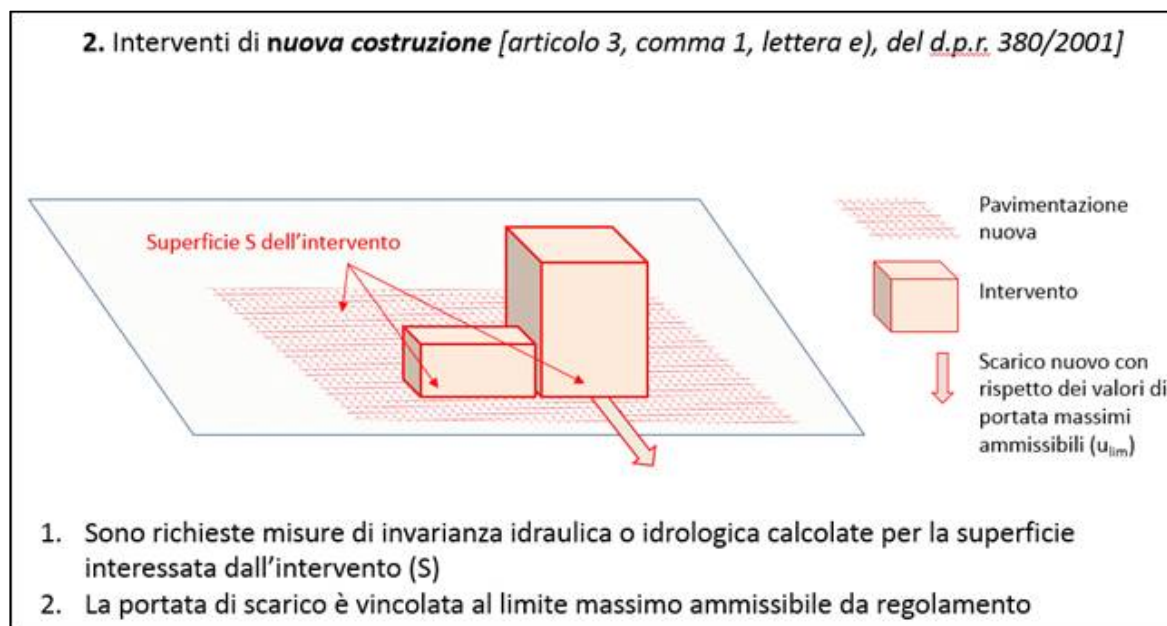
stralcio allegato A del R.R. 7/2017 e s.m.i.
